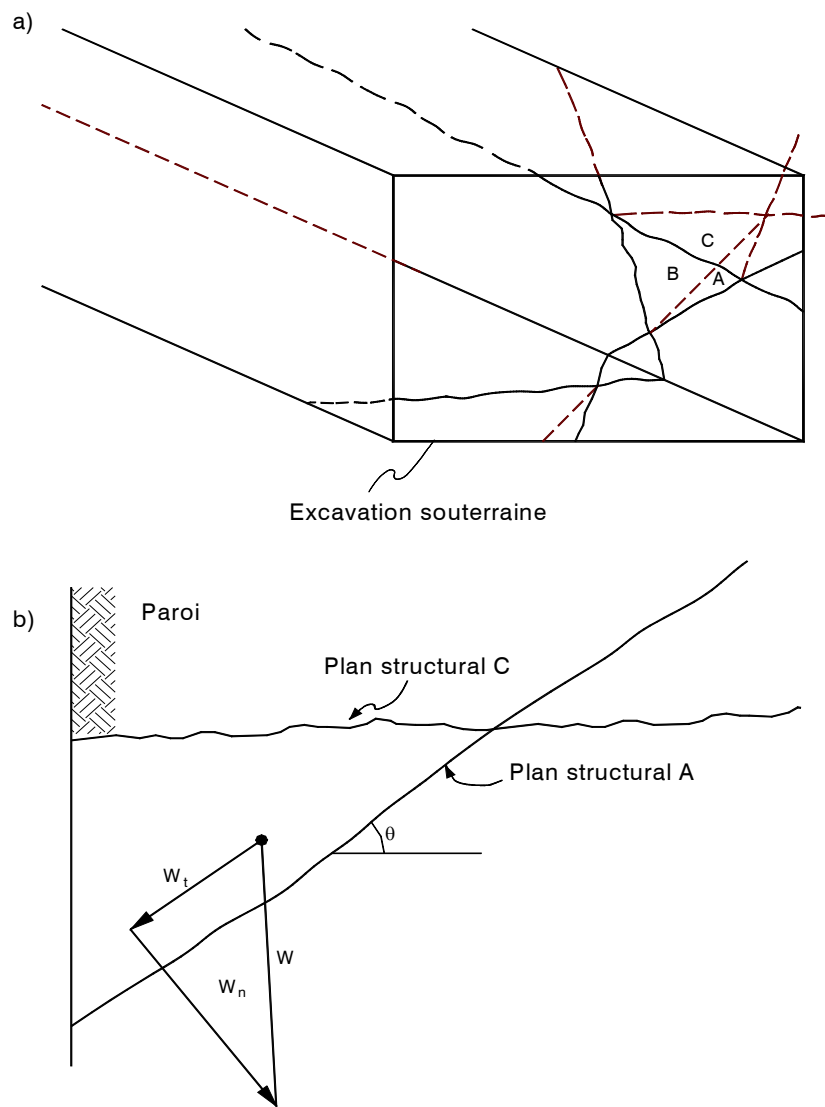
Formulation de l'équation du facteur de sécurité contre le glissement sur un plan. (a) : Tétraèdre complètement exposé, formé par trois plans structuraux qui se rencontrent à proximité d'un parement de voie horizontale et dont le mode d'instabilité potentielle est le glissement sur un plan préalablement à une chute dans l'excavation. (b) : Section verticale contenant la ligne de pendage du plan de glissement.
